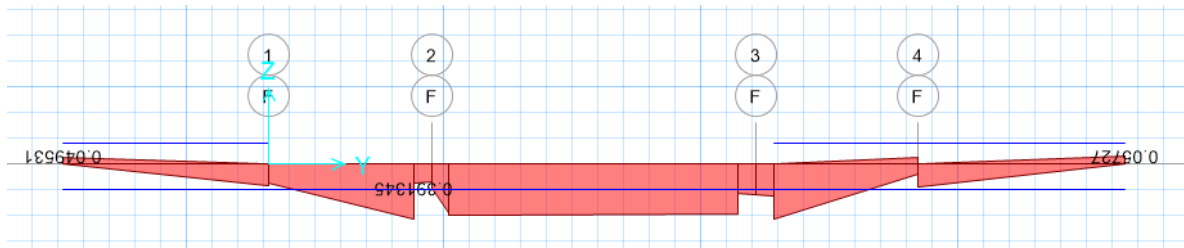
Área de refuerzo en dirección y por franja (losa de sistema de soportes)
